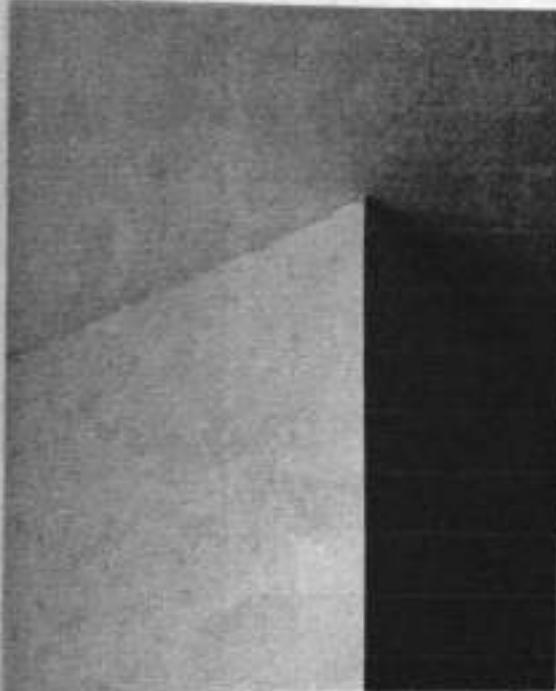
FISURAS BORDE DE PARED APTO. (2)
